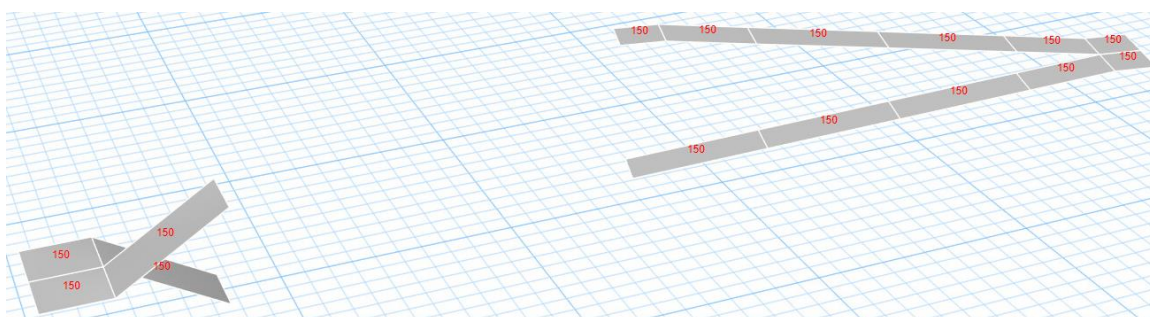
Carga muerta en losas de Escalera y Rampa (kg/m²)
